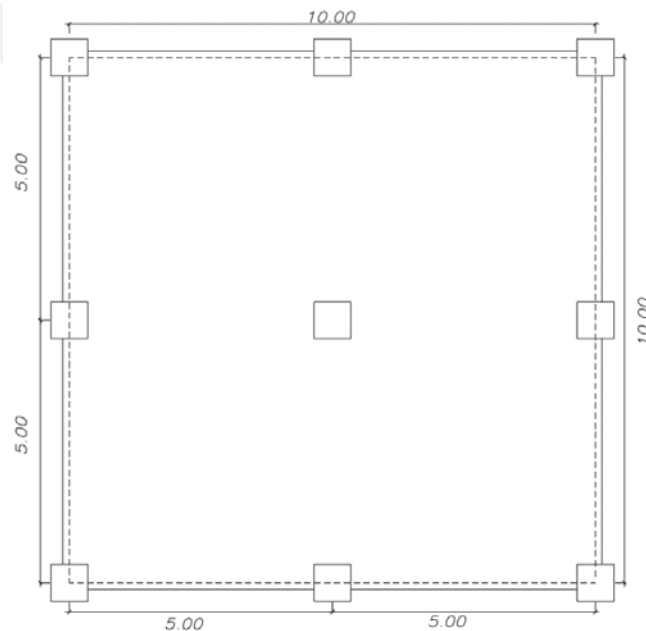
Caso 2 - Planta sin vigas peraltadas, losa plana apoyada solo en las columnas
